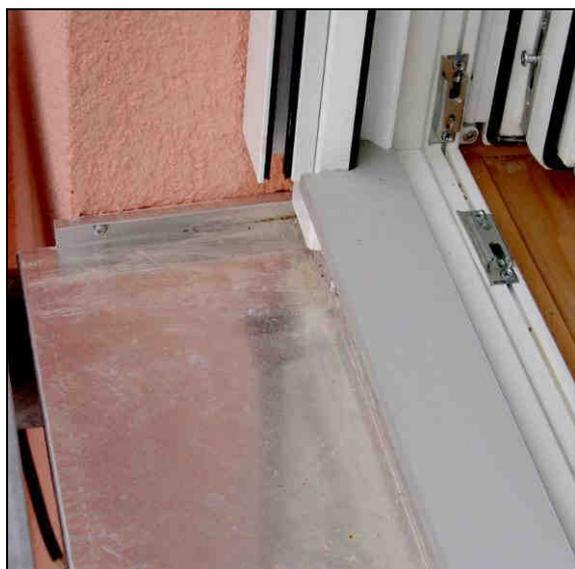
Anschluss Balkon/ Fenstertür
